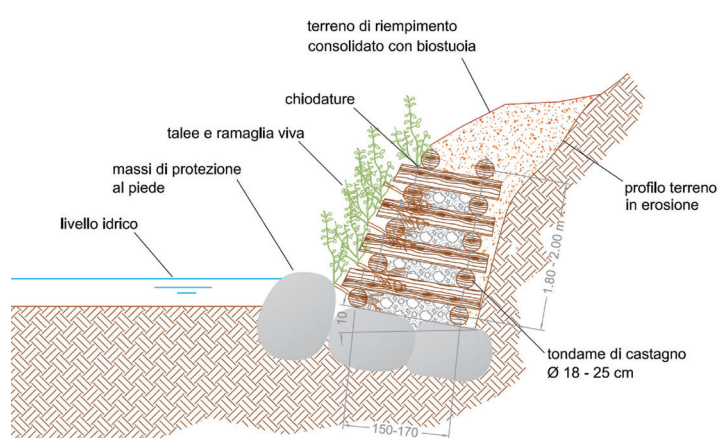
SEZIONE DI UN INTERVENTO TIPO.
